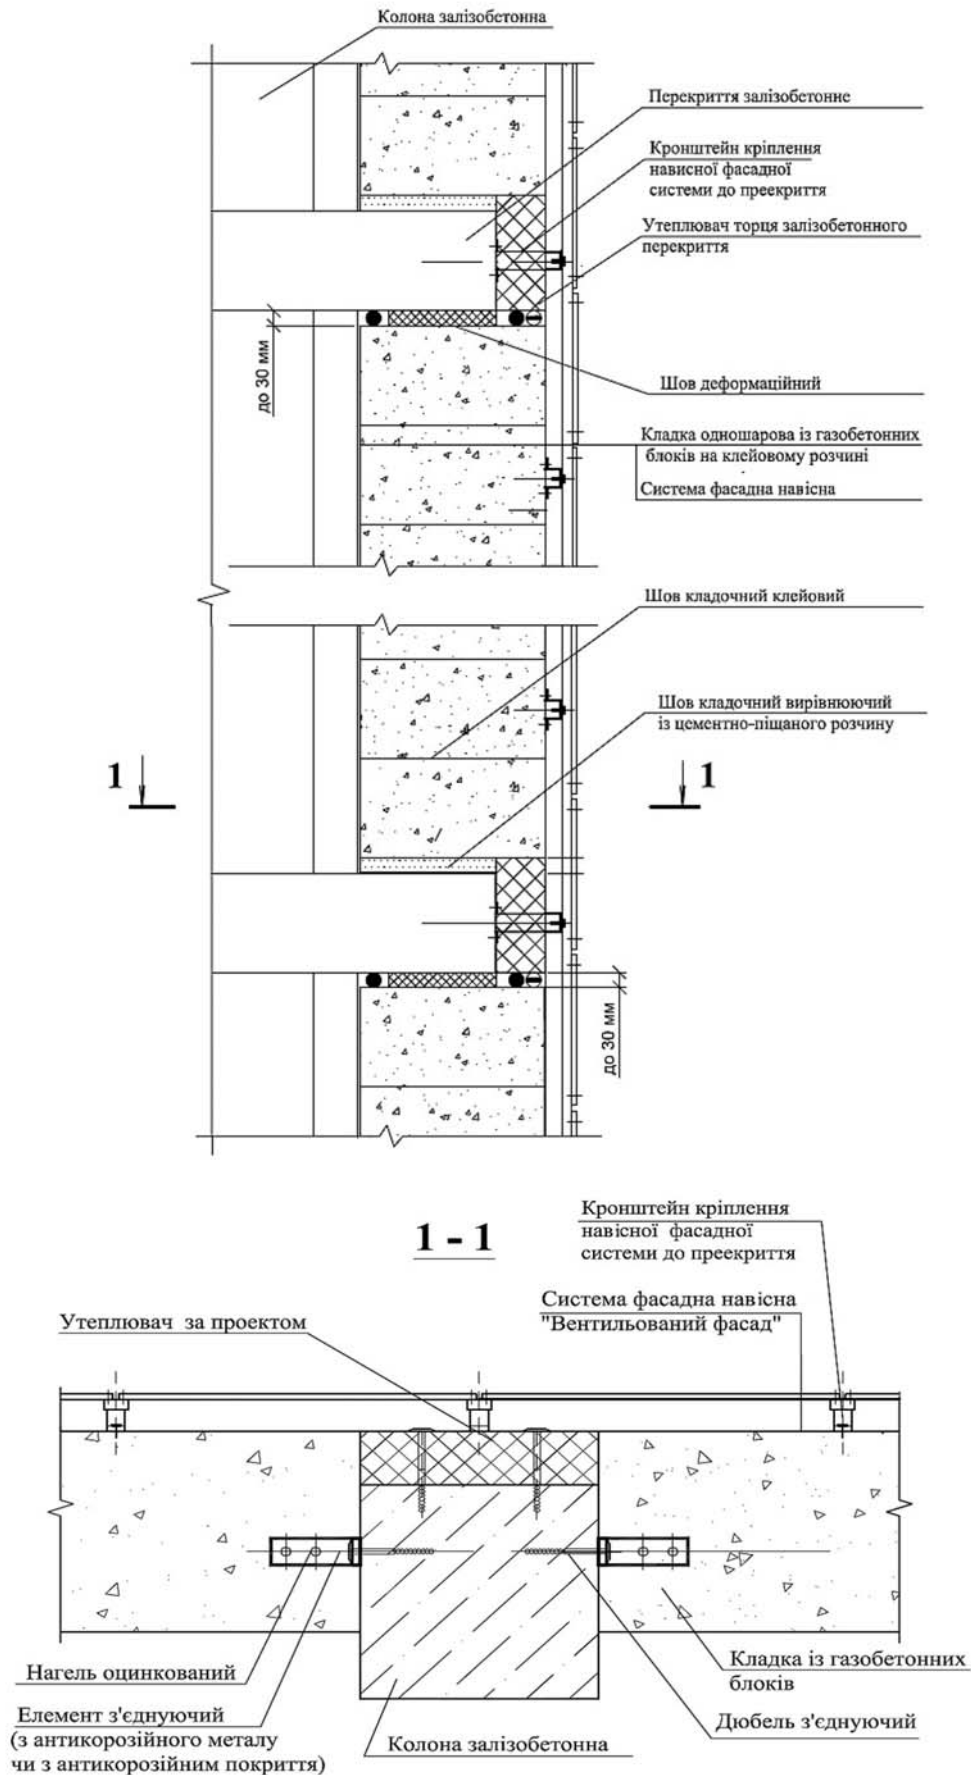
Стіна зовнішня багатшарова із газобетонних блоків із навісною фасадною системою
